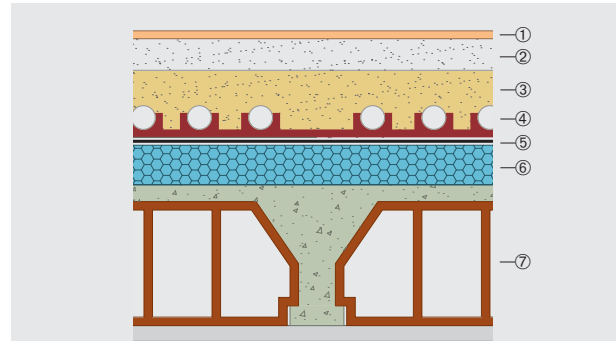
>> Aislamiento térmico bajo forjados sobre cámaras de aire
